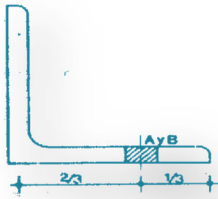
Perfil L. Fuente: Diseño de estructuras de acero de McCormac
